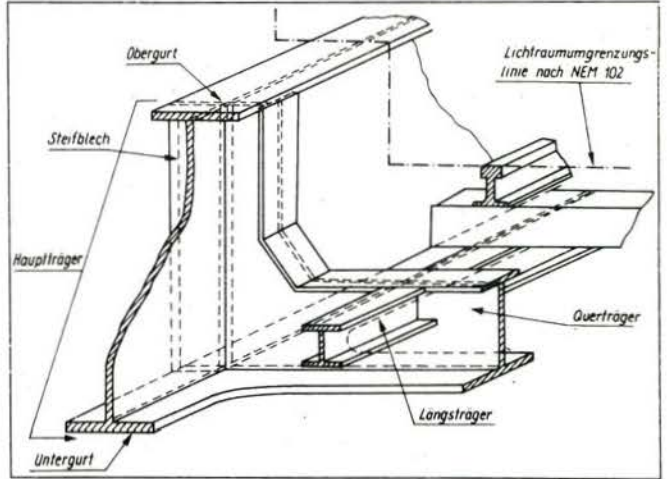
Zur Fachwerkbrücke besteht nur insofern ein Unterschied, als der Querträger nicht an einen Hauptträger, sondern an ein senkrechtes Fachwerkteil angeschlossen ist. Fachwerkbrücken werden meist dort angewandt, wo
